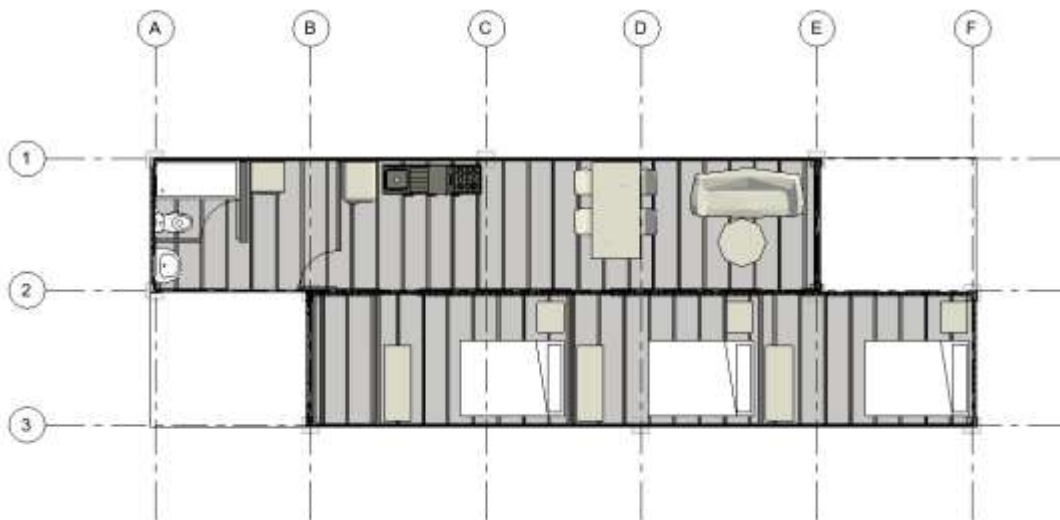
, Planta diseño general Revit, 2025-II, Wilson Lozano
